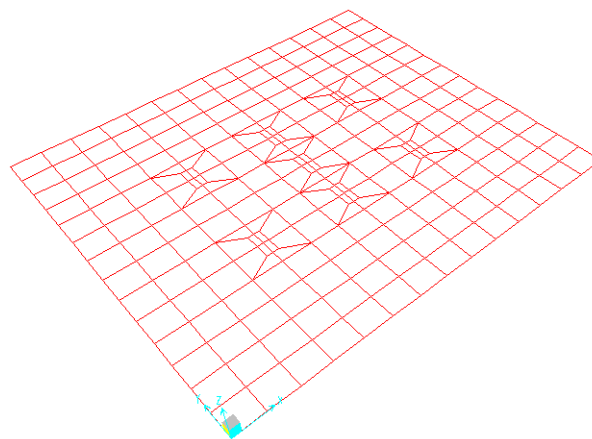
Vista 3D da discretização do Painel (SAP2000).
